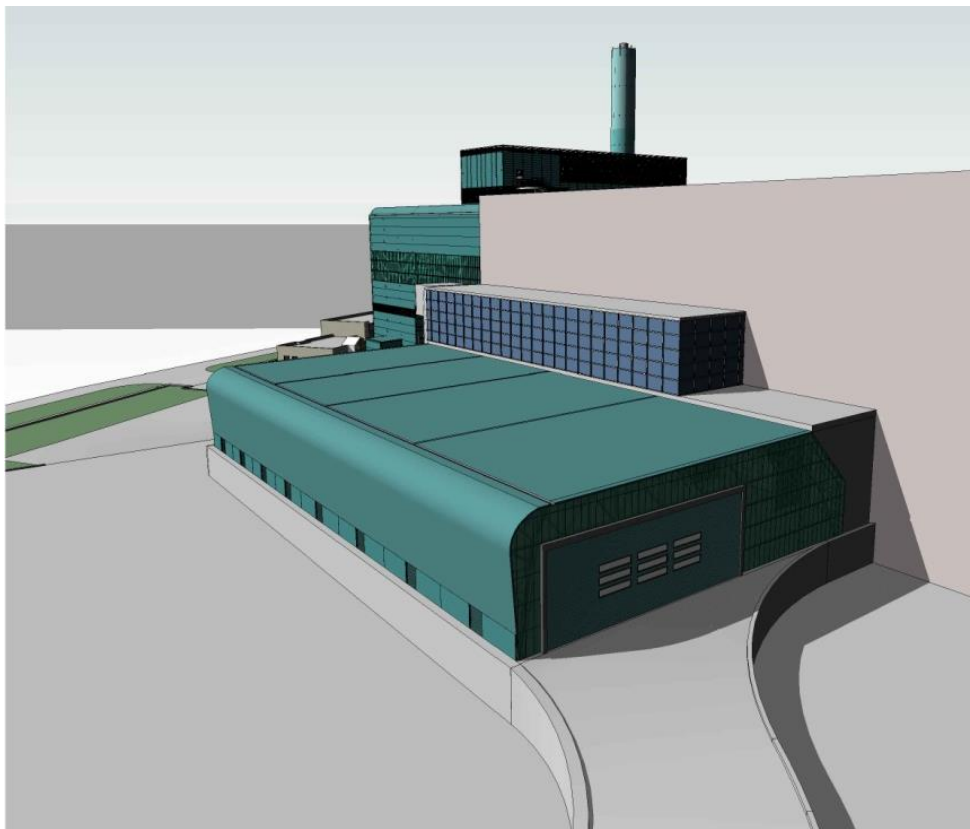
Vista di insieme dell'Avanfossa di progetto con il piazzale per il conferimento
